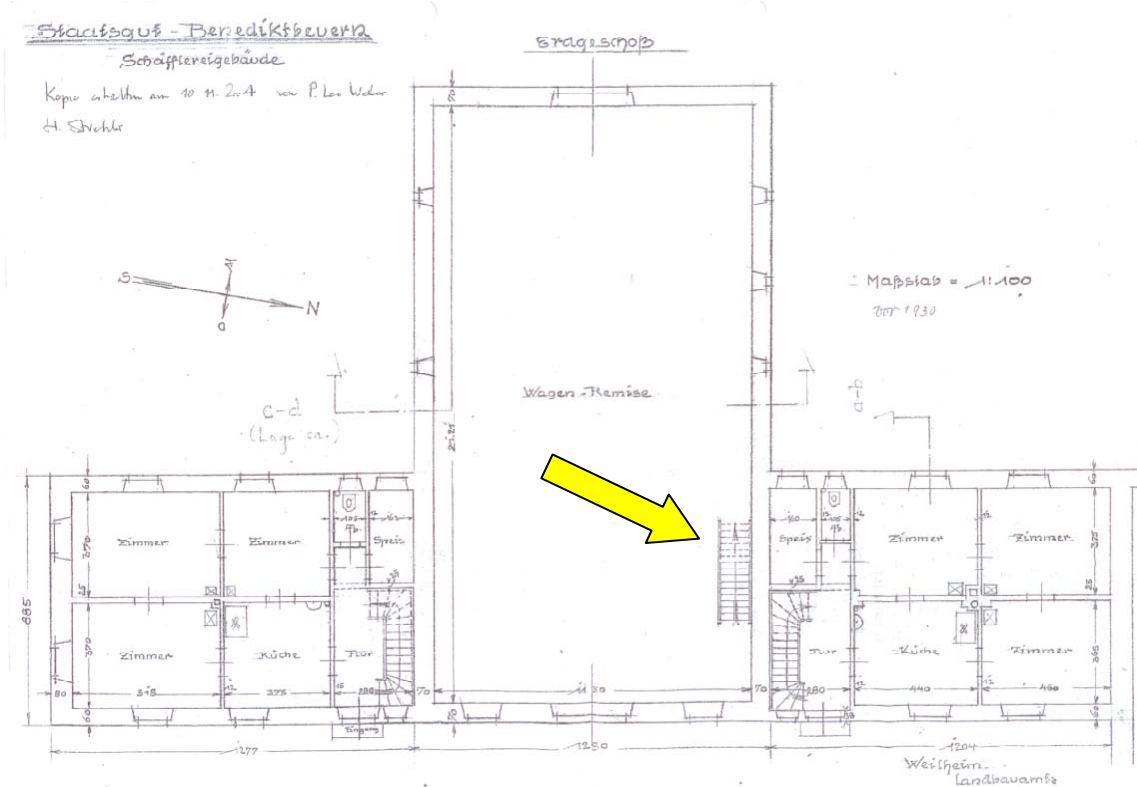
Grundriss EG, Landbauamt Weilheim, 1930
